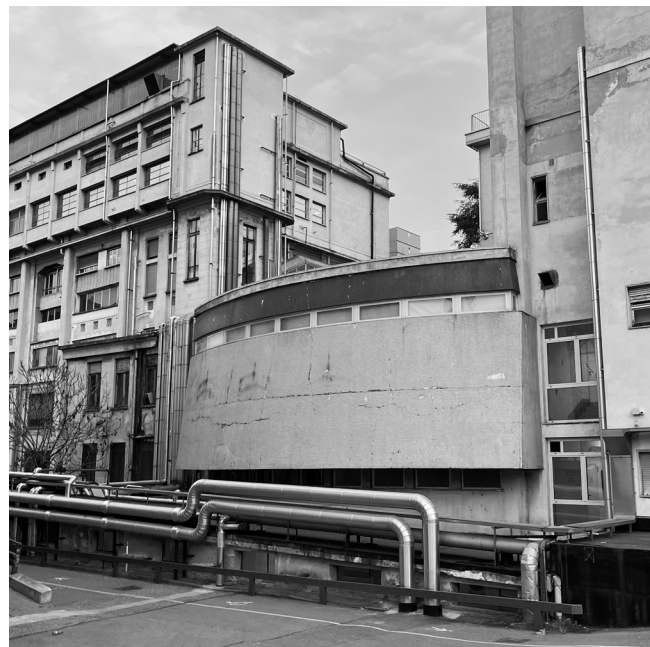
foto all'interno dell'area dei padiglioni, elaborazione dell'autore
